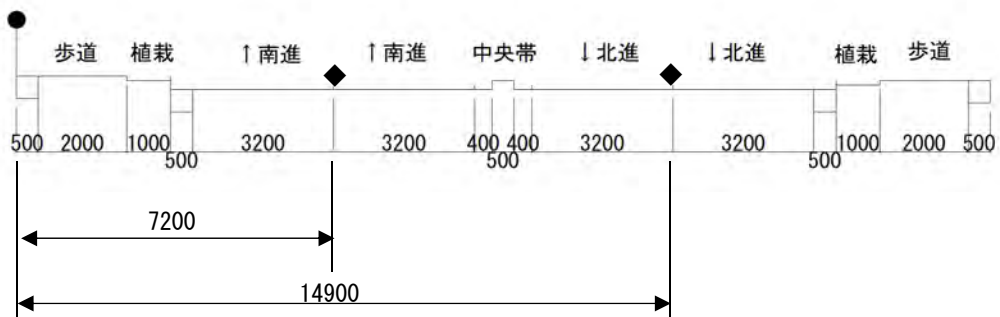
音源配置図 (道路延長方向の配置イメージ)
